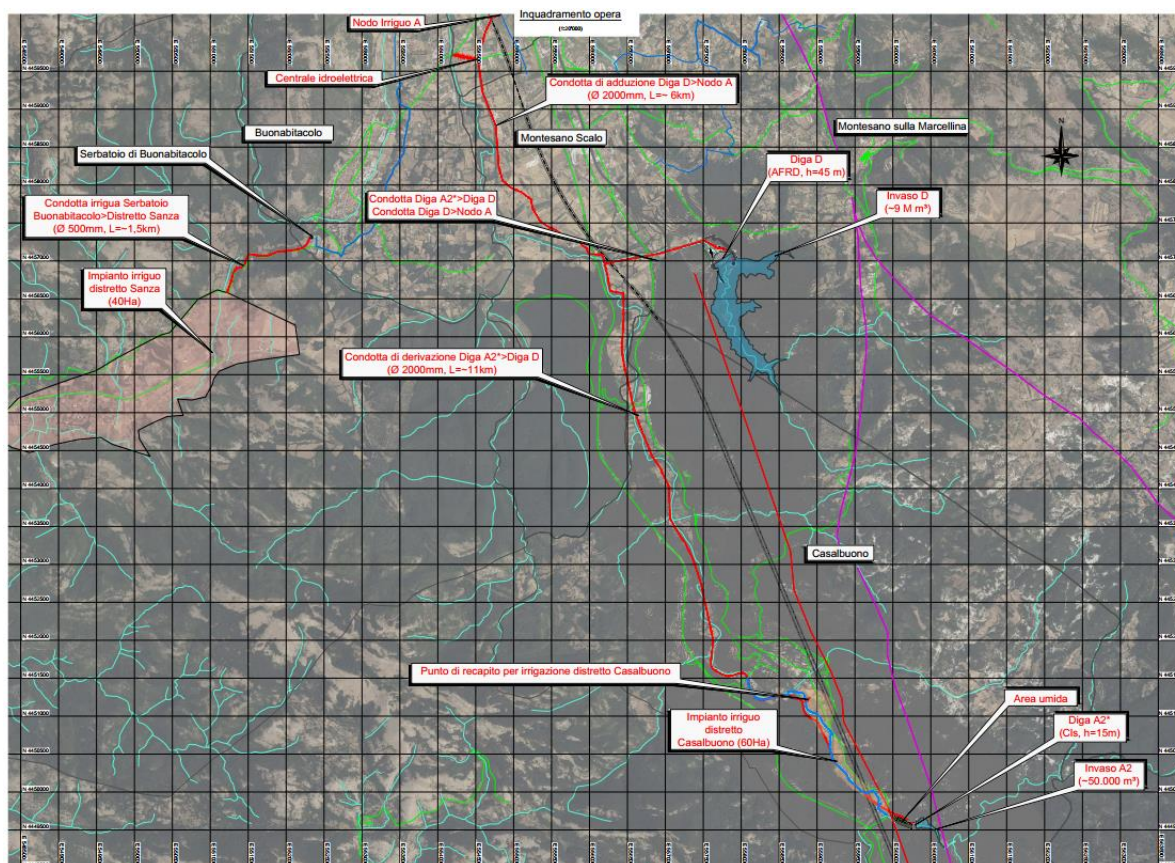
Alternativa 2 (A2*+D), schema progettuale planimetria (estratto da [28])
